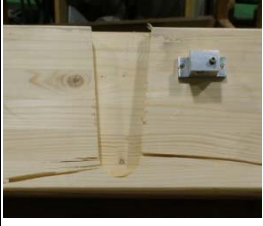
Modificación del apoyo de las viguetas en los ensayos
